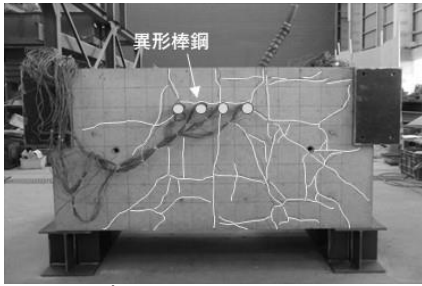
コンクリート表面のひび割れ (Case-4側面)
